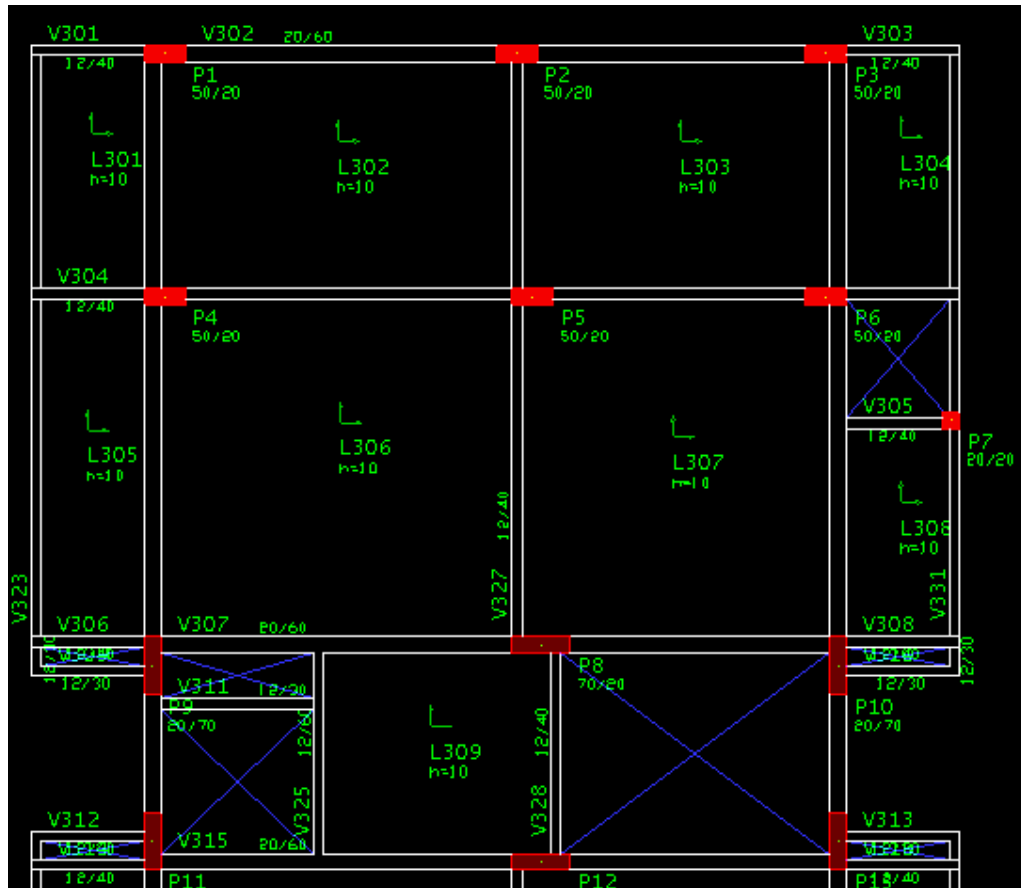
Planta de formas da cobertura e piso da casa de máquinas (obs.: o pavimento é simétrico, dimensões da outra metade são iguais às da primeira)
